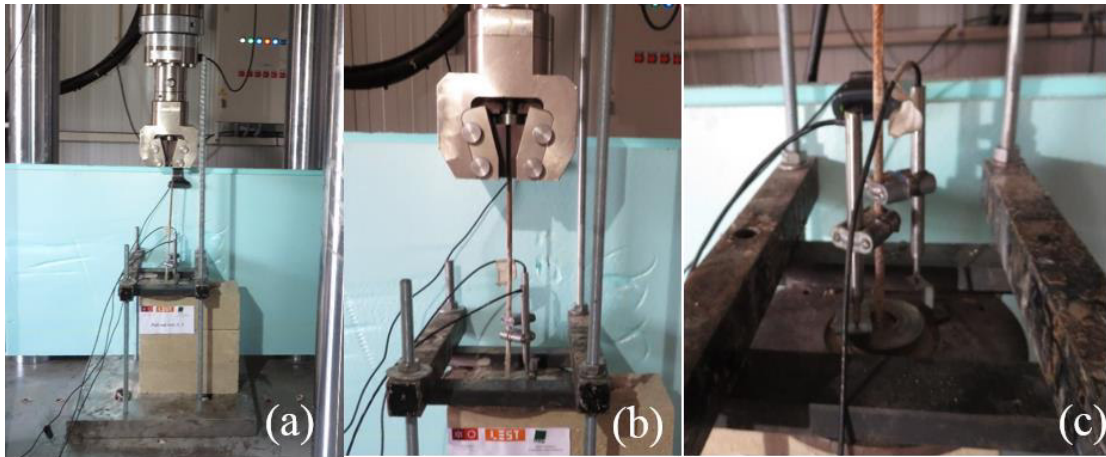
Ensaio de arrancamento: a) esquema de ensaio; e b) pormenor de amarra utilizada (c) colocação dos LVDT.
